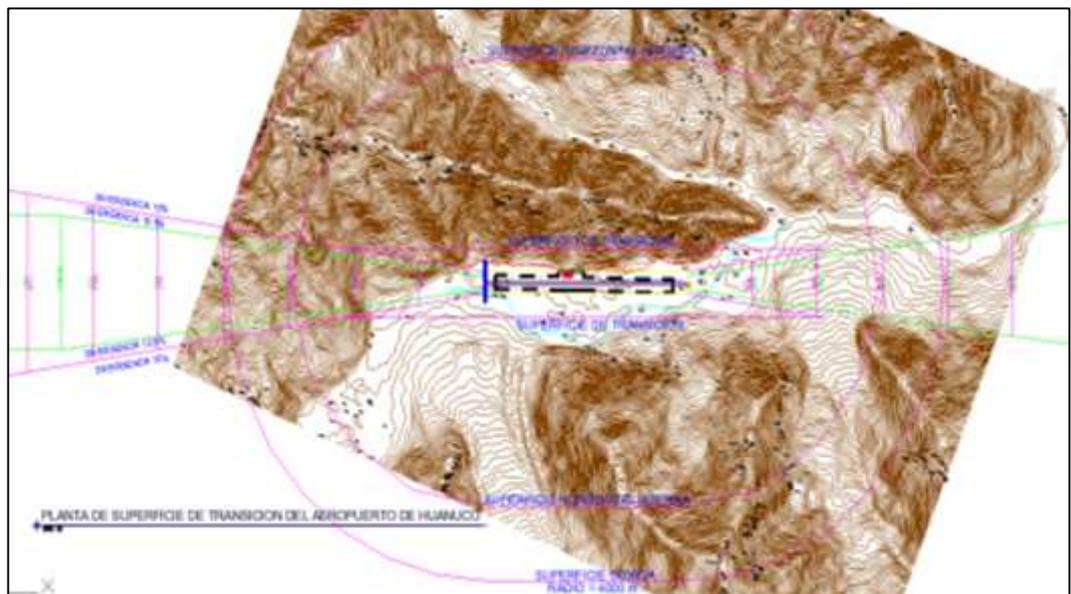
Plano topográfico del aeropuerto de Huánuco; Fuente: Elaboración propia
